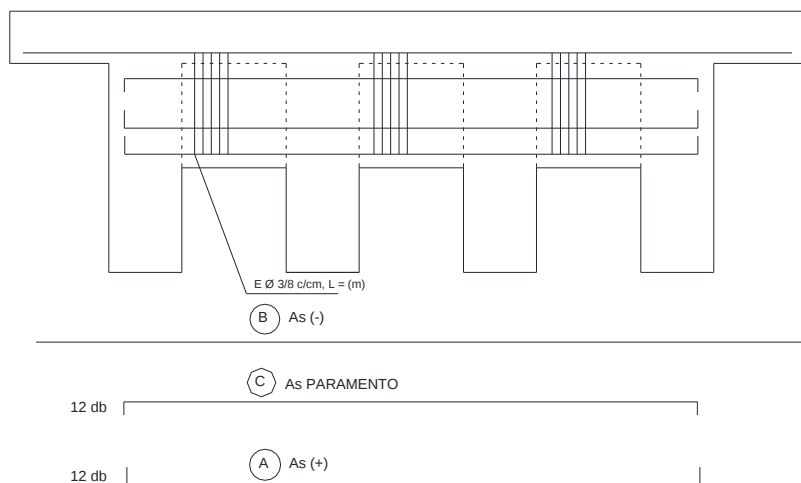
Sección Longitudinal del Separador Interno y su despiece.
